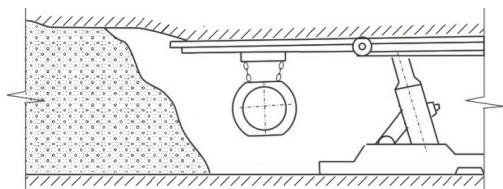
Схема сечения крепи с завальной консолью и породопроводом
